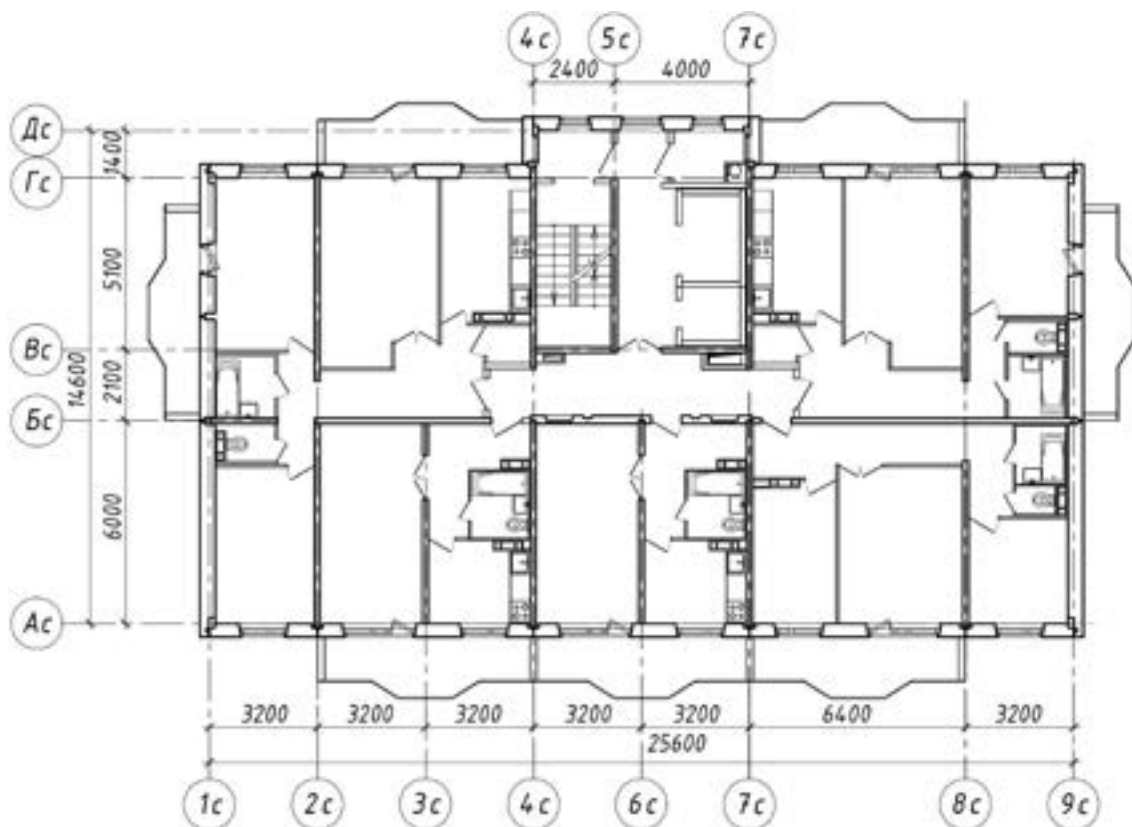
Планировочное решение крупнопанельного жилого дома 75-й серии
